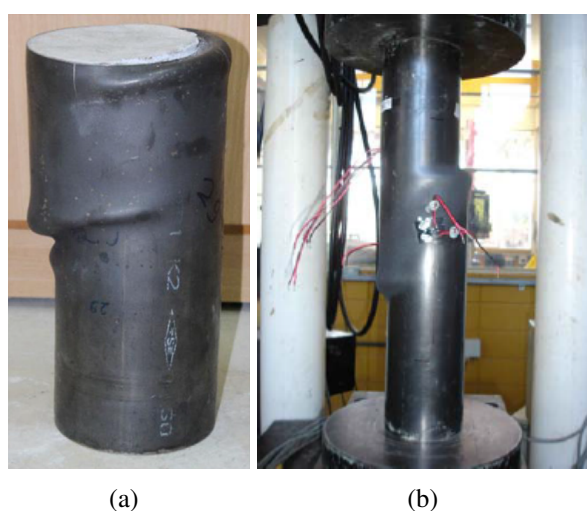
Ruptura por enrugamento do perfil de aço na amostra 114,3-2,74-300-66 (EKMEKYAPAR E AL-ELIWI, 2016) (a) e por cisalhamento do núcleo de concreto na amostra P1-60-5D-3 (OLIVEIRA, 2008) (b).
